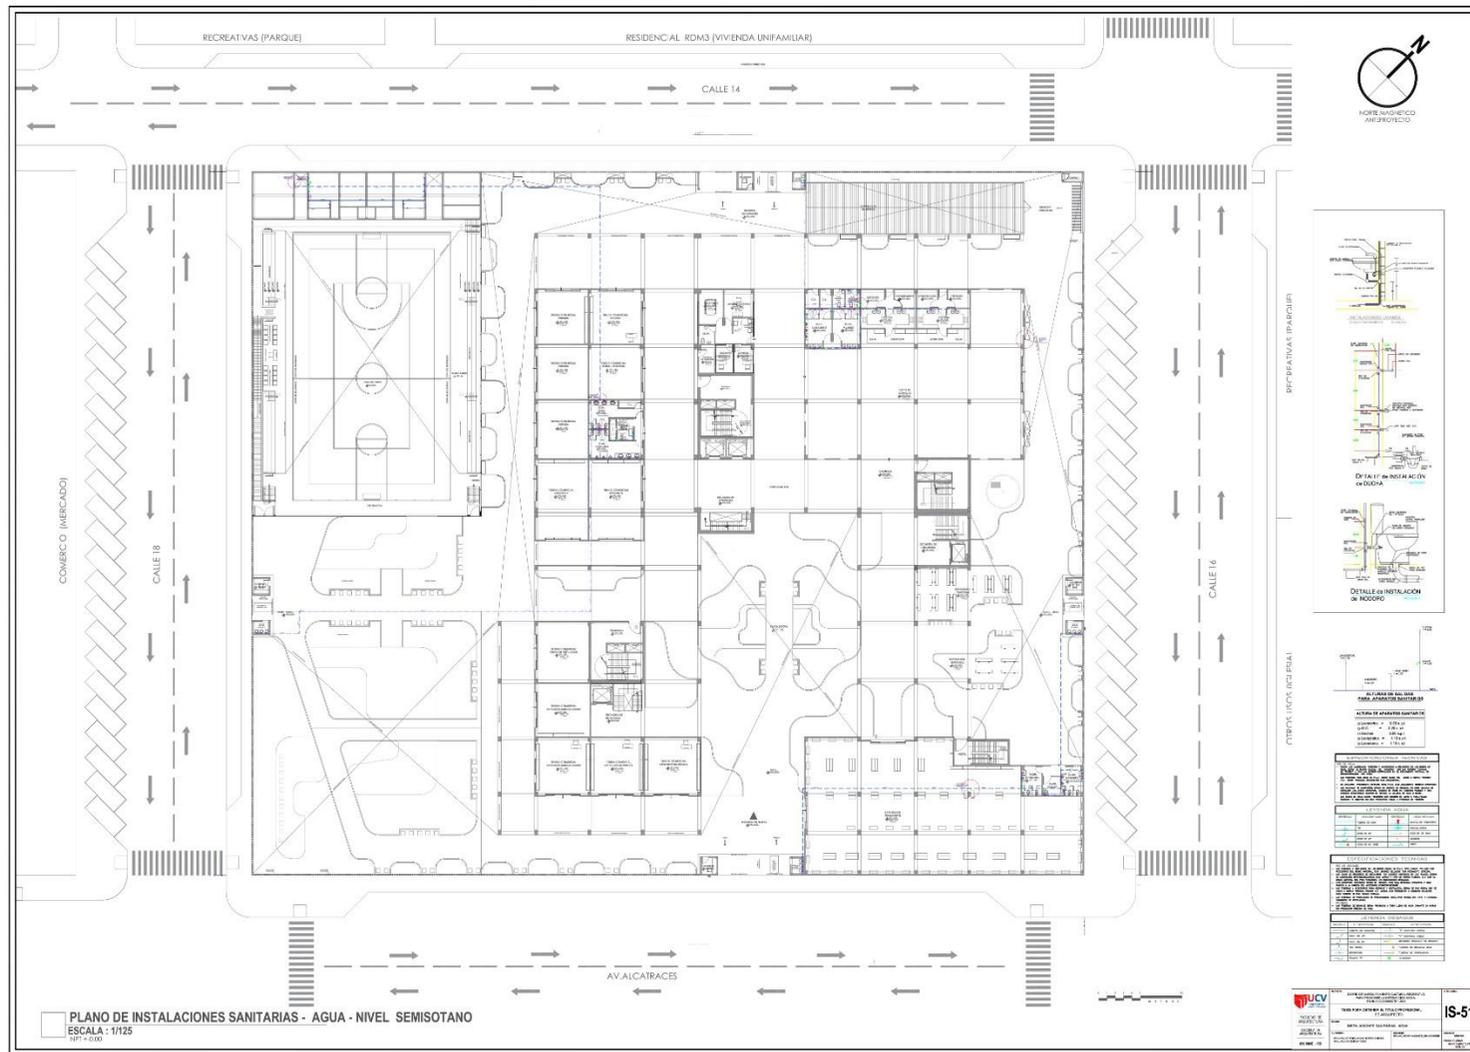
Plano de Instalaciones Sanitarias 1 Nivel
